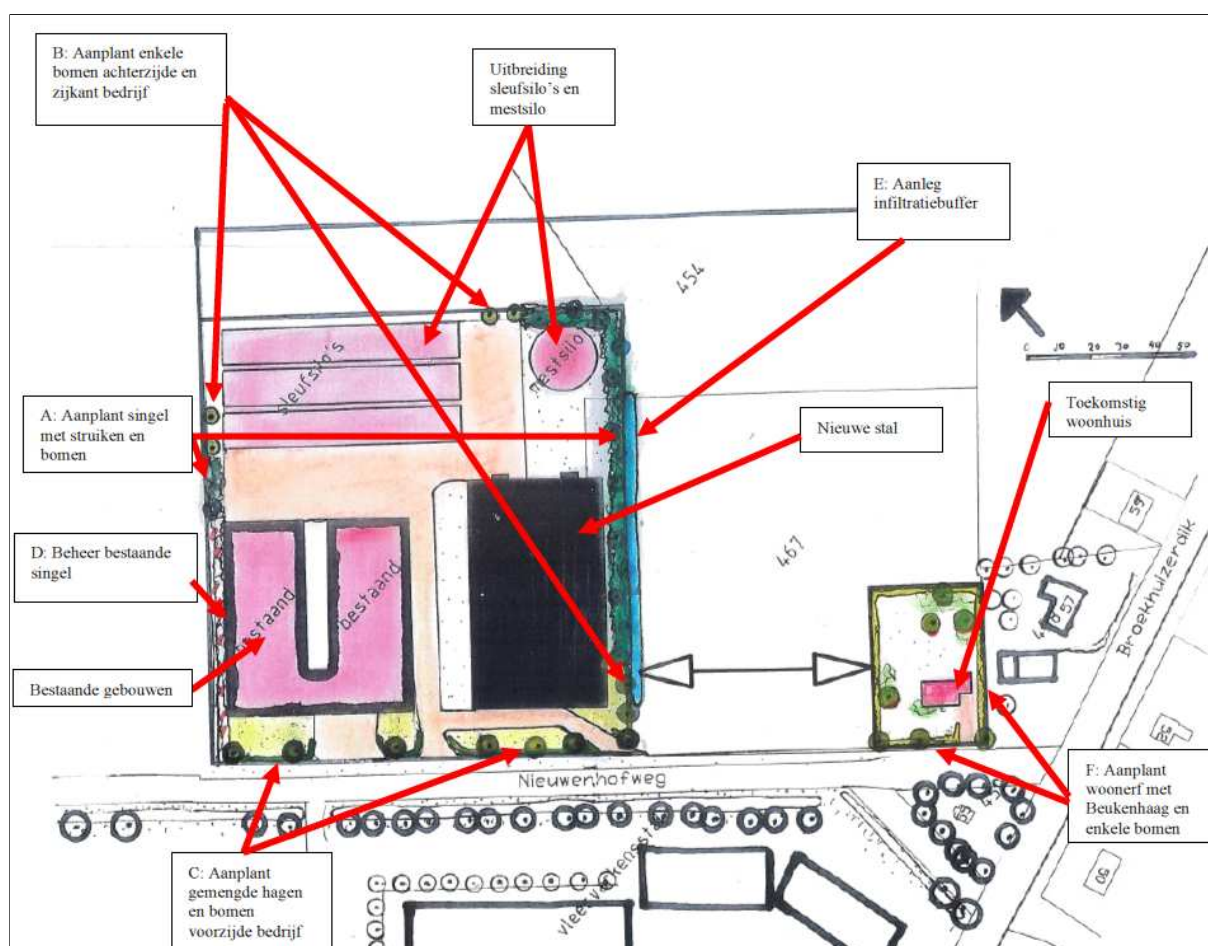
, Vigerend bouwvlak en bebouwing en te realiseren gebouwen, bouwwerken en bouwvlak (let op: tekening is niet op schaal).
